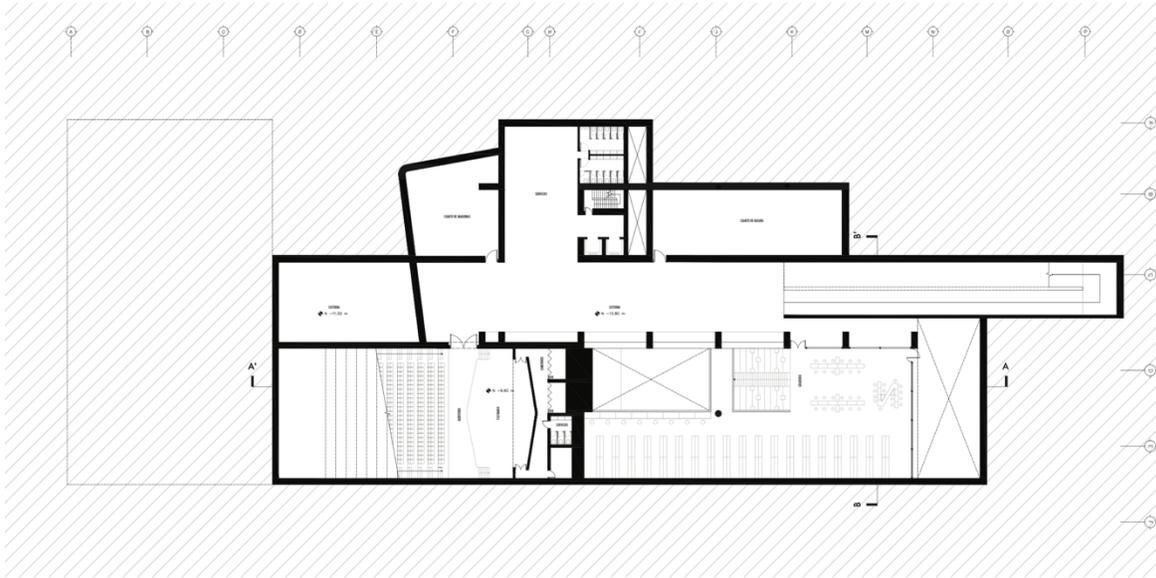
Planta subsuelo 2, N -10.80m. Esc 1:400
